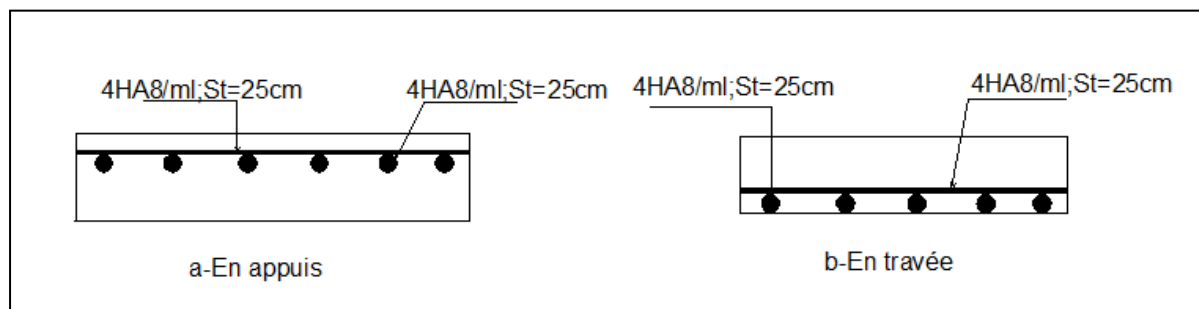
Schéma de ferrailage de la dalle sur deux appuis.
